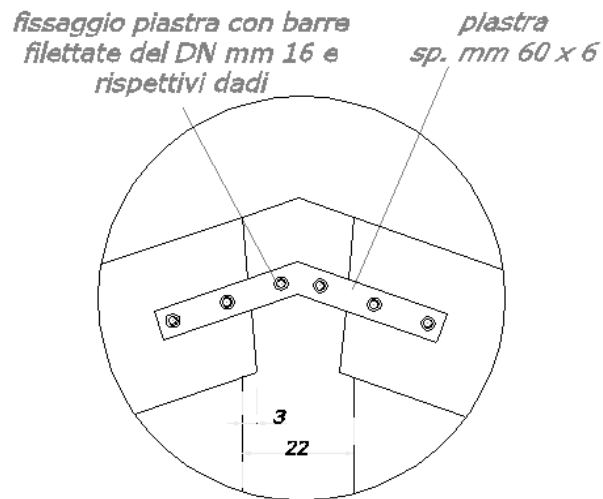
Particolare 2, collegamento Monaco-Puntone
